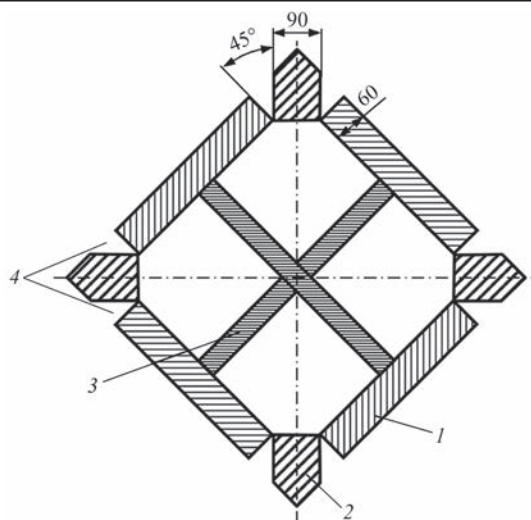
Схема сборки стыков для сварки элементов усиления проемов поясов строительной колонны типа «мальтийский крест»: 1 — поперечное сечение пояса колонны; 2 — элемент усиления колонны; 3 — ребро жесткости; 4 — сварные стыки стали 06ГБ-390 (ТУ У 27.1-05416923-085-2006) толщиной 50 мм, а элементы усиления их проемов из стали 09Г2С-15 (ГОСТ 19281-89). Отличительной особенностью стали 06ГБ является ее хорошая свариваемость, высокая сопротивляемость замедленному разрушению и образованию холодных трещин по сравнению с известными марками низколегированных сталей данного класса прочности [10].
